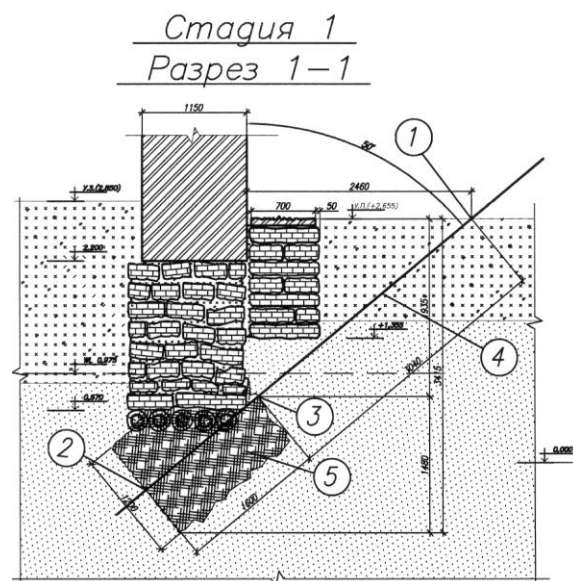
Схема работ по закреплению грунта несущего слоя фундамента методом «Jet Grouting».
